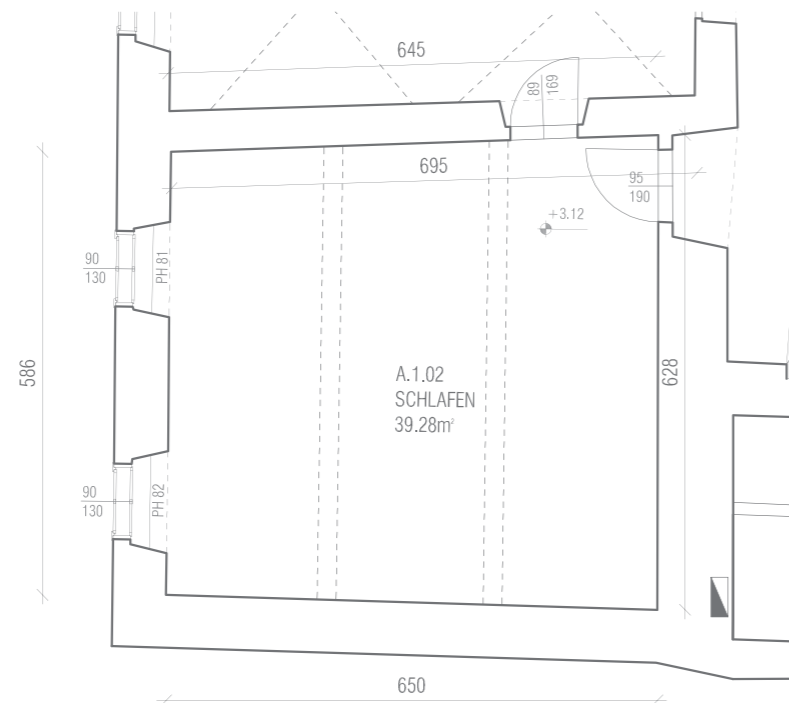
Grundriss Raum A.1.02_1:100
